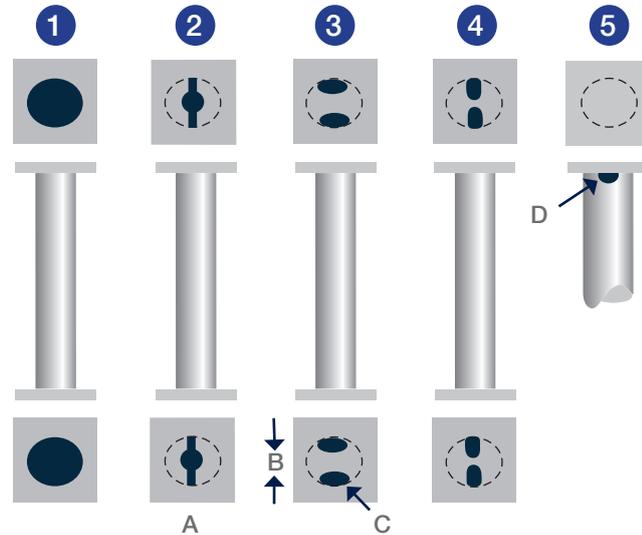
Colonnes, poutrelles tubulaires, lampadaires et poteaux de ligne de transmission
